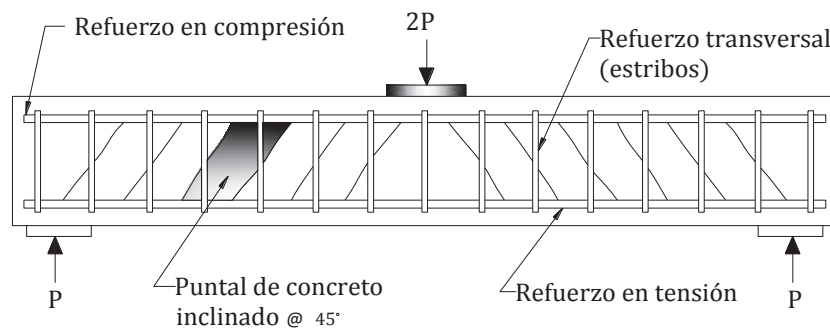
Modelo armadura para vigas de concreto sujetas a cortante
